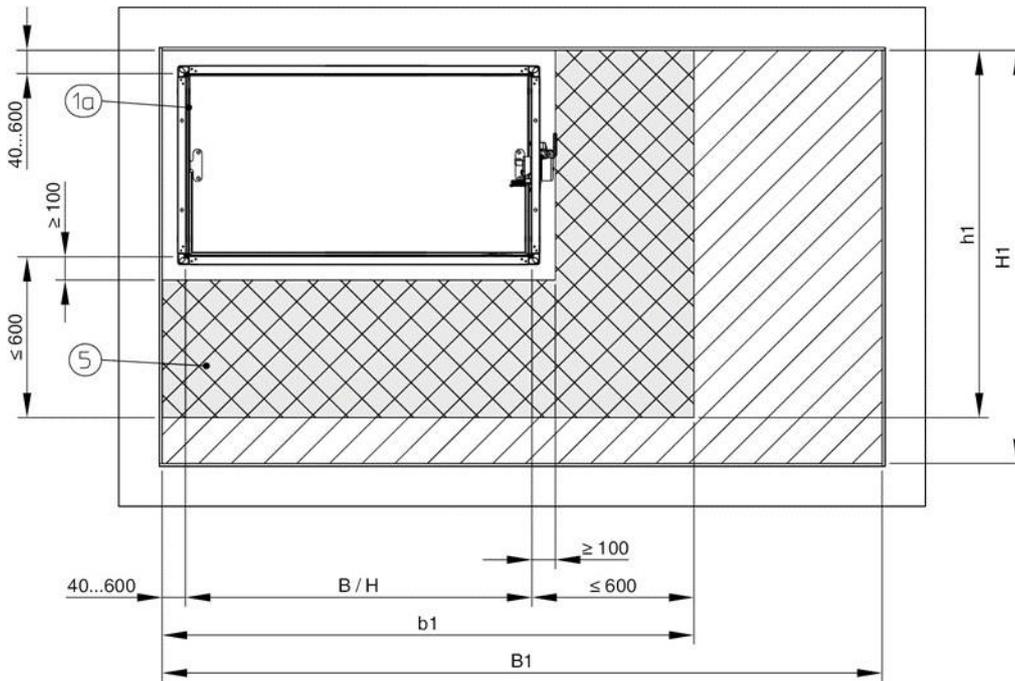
Disposition dans le calfeutrement de pénétration mixte FK2-EU – distances à la première conduite
